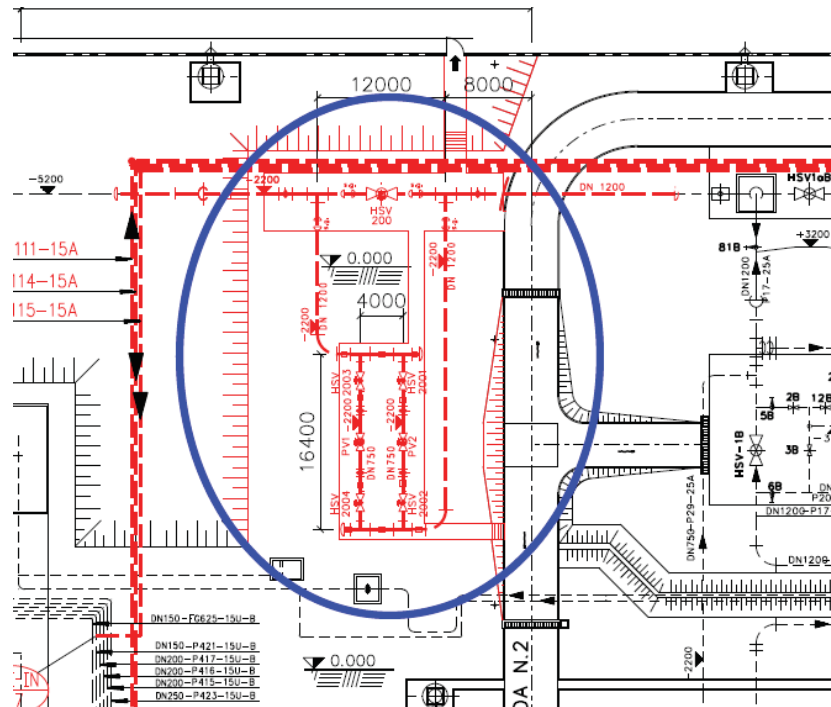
Stralcio planimetrico gruppo di regolazione
